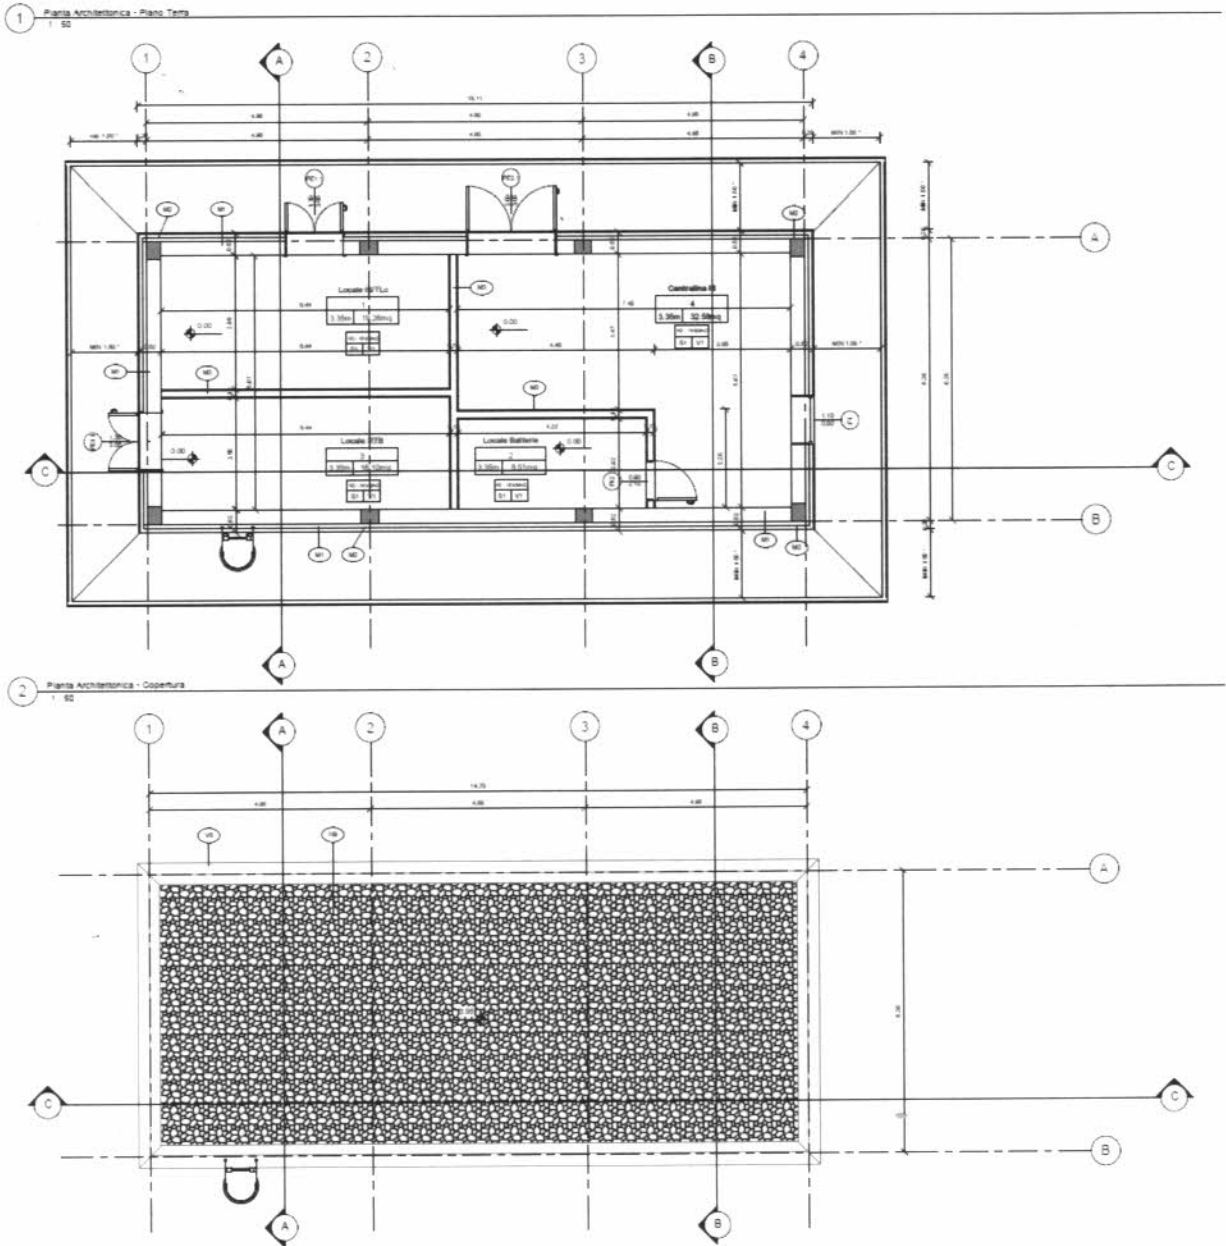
Pianta Architettonica Piano Terra – Layout T4.E
